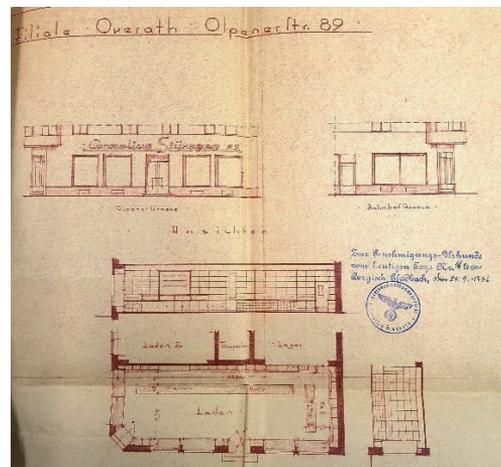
Grundrisssskizze zum Umbau der *Stüssgen Filiale* am Overather Bahnhof.
